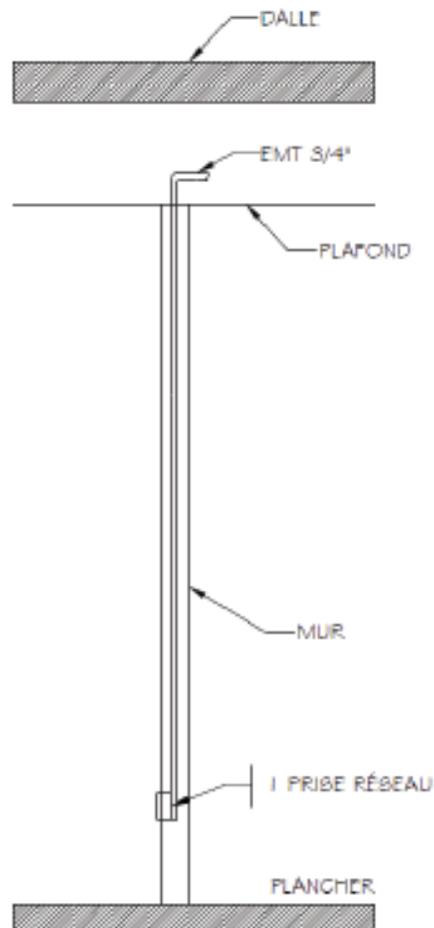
Installation prises réseau : Plan de coupe - Conduit et prise réseau
